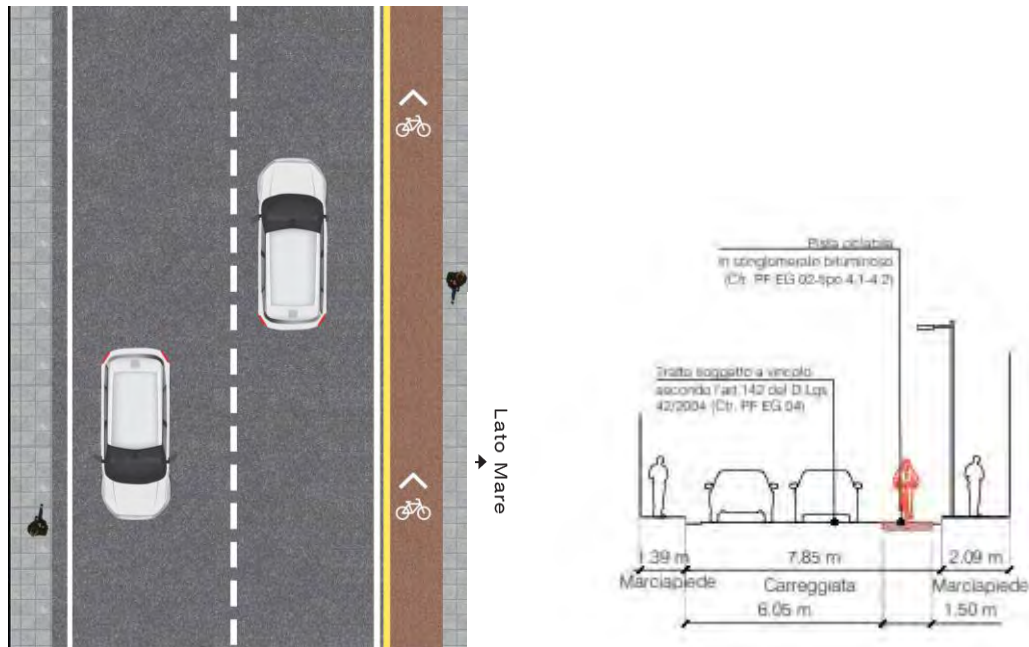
Sezione trasversale e pianta di progetto Stradone Vigliena
